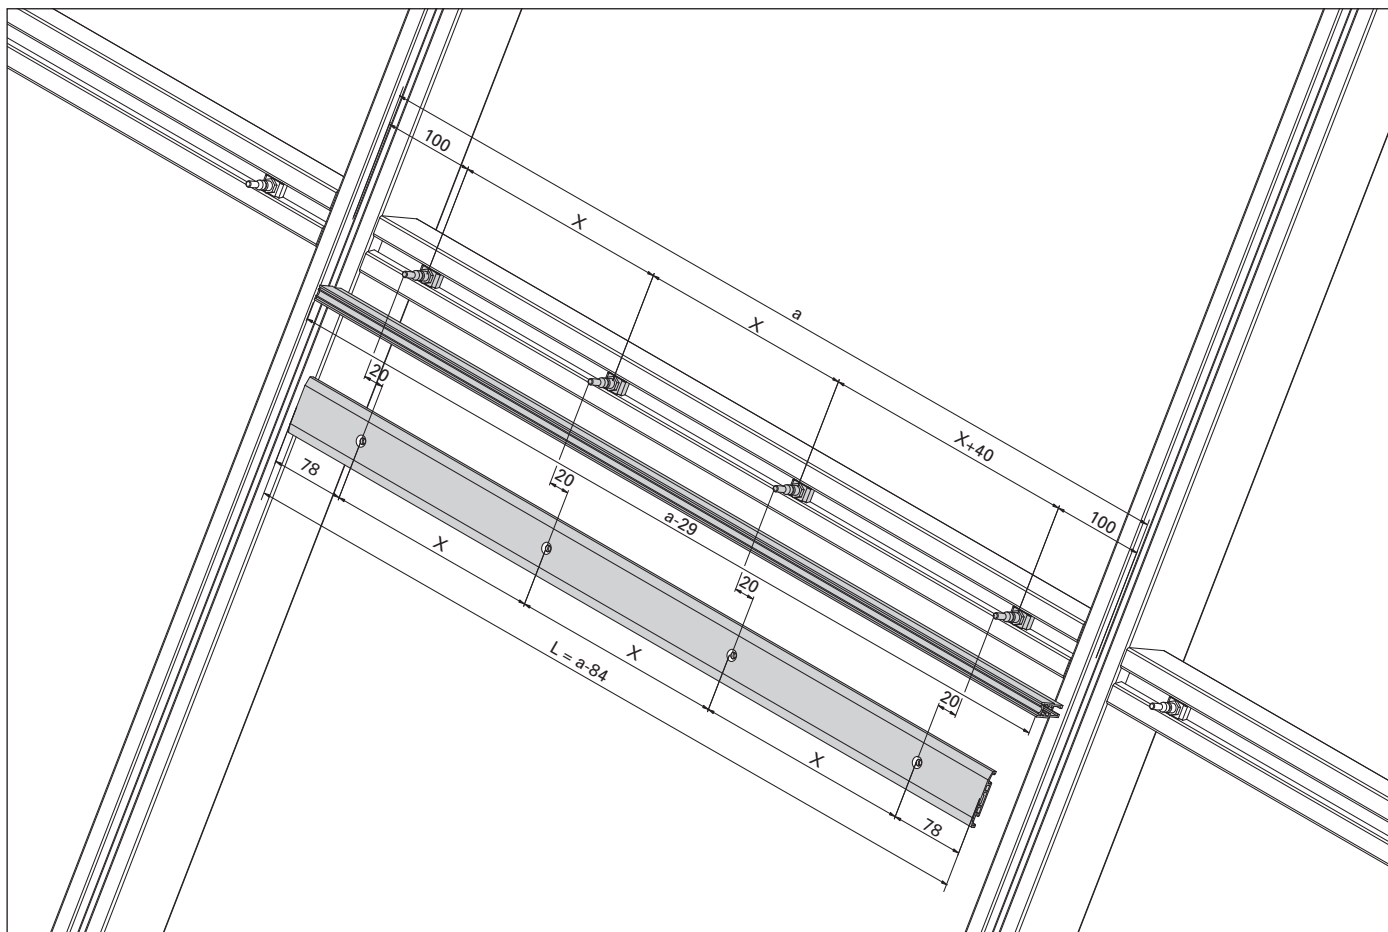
Zuschnitt und Bearbeitung Riegel-Falz- und Anschraubprofile
